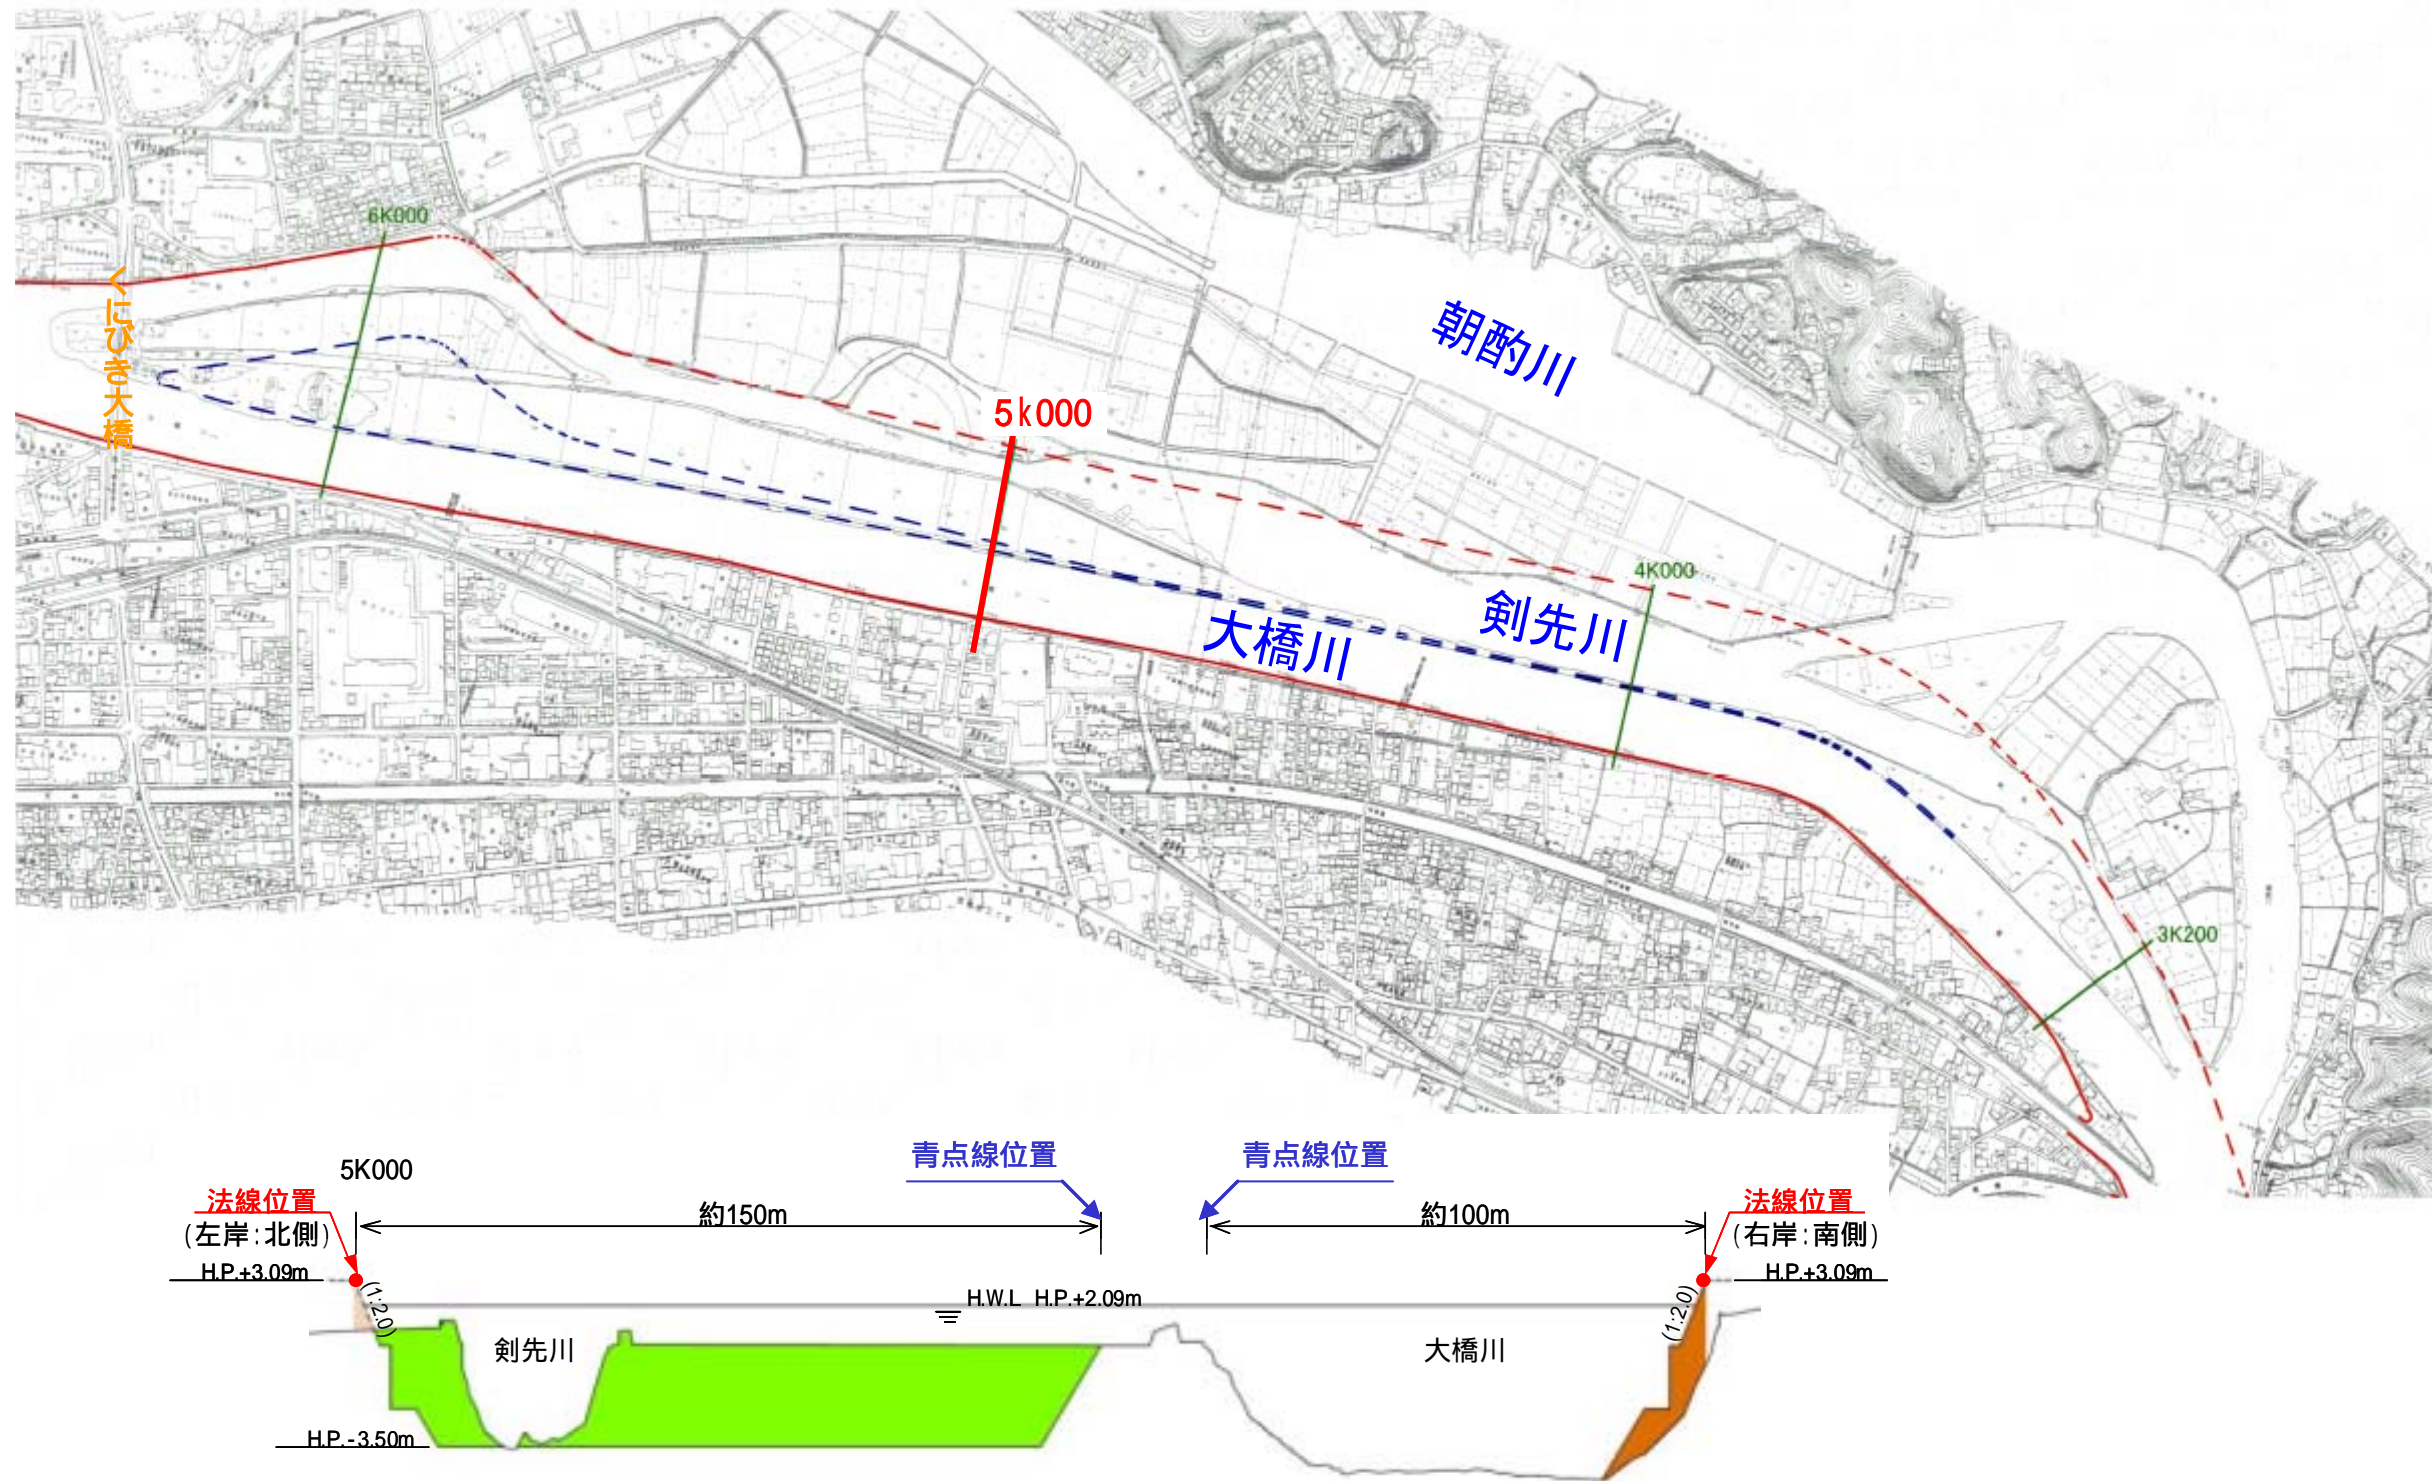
(2) 大橋川改修案の平面図・横断面図(中流部)
